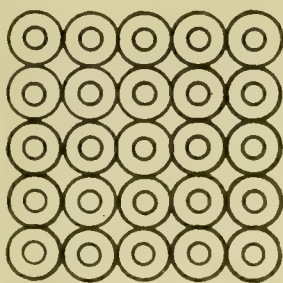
Plan indiquant la disposition des pierres spéciales sur le fond du lit bactérien.
